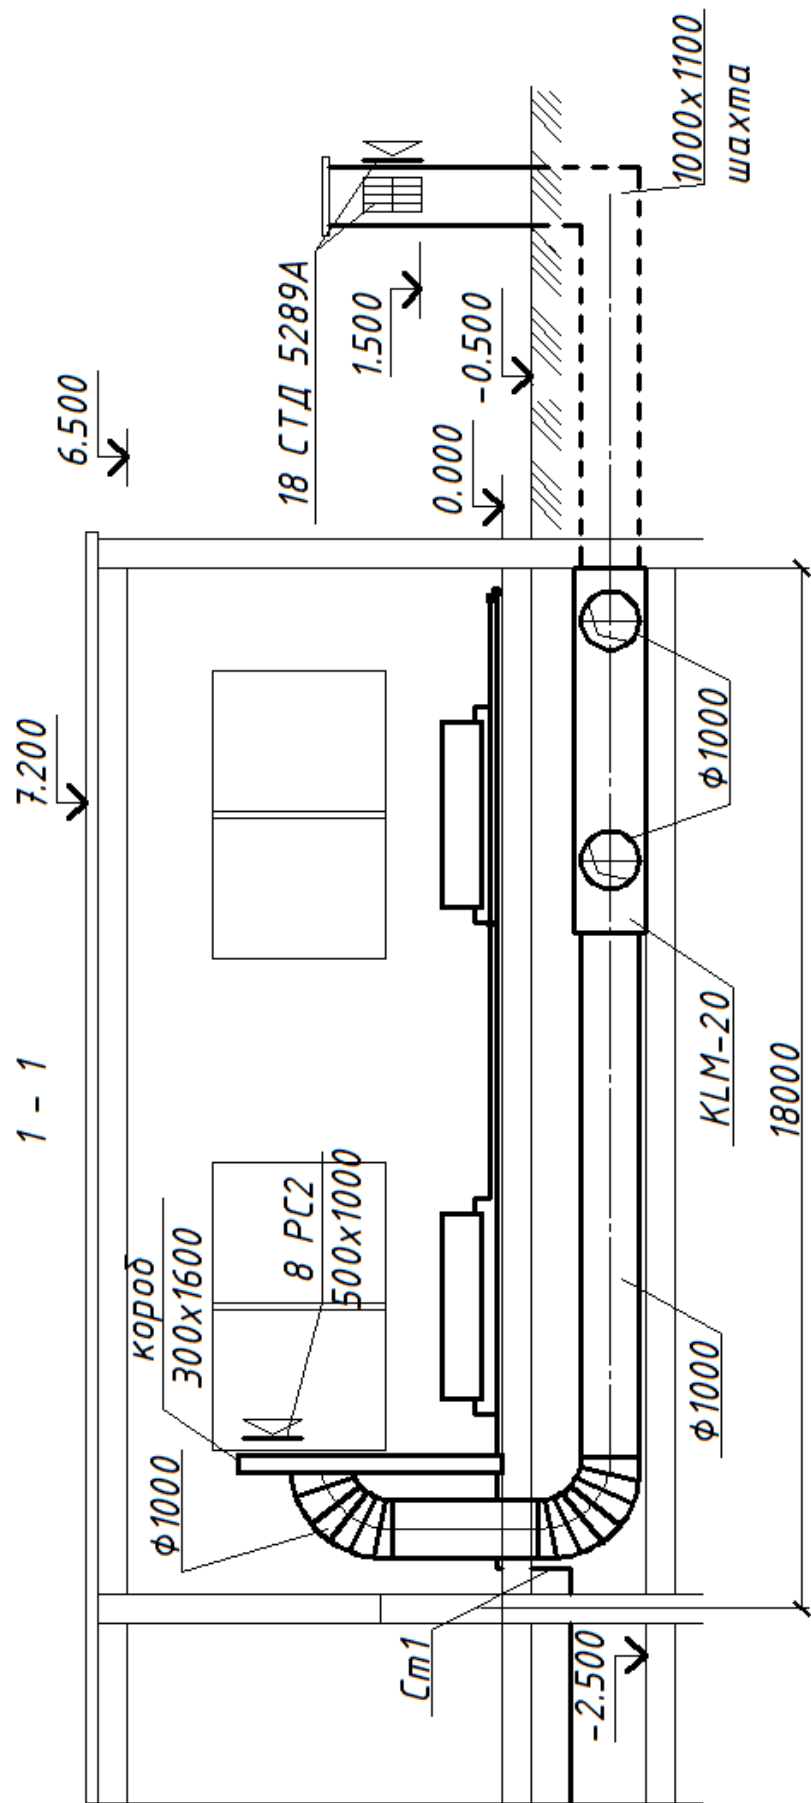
Разрез 1-1 с нанесением отопительно-вентиляционного оборудования
